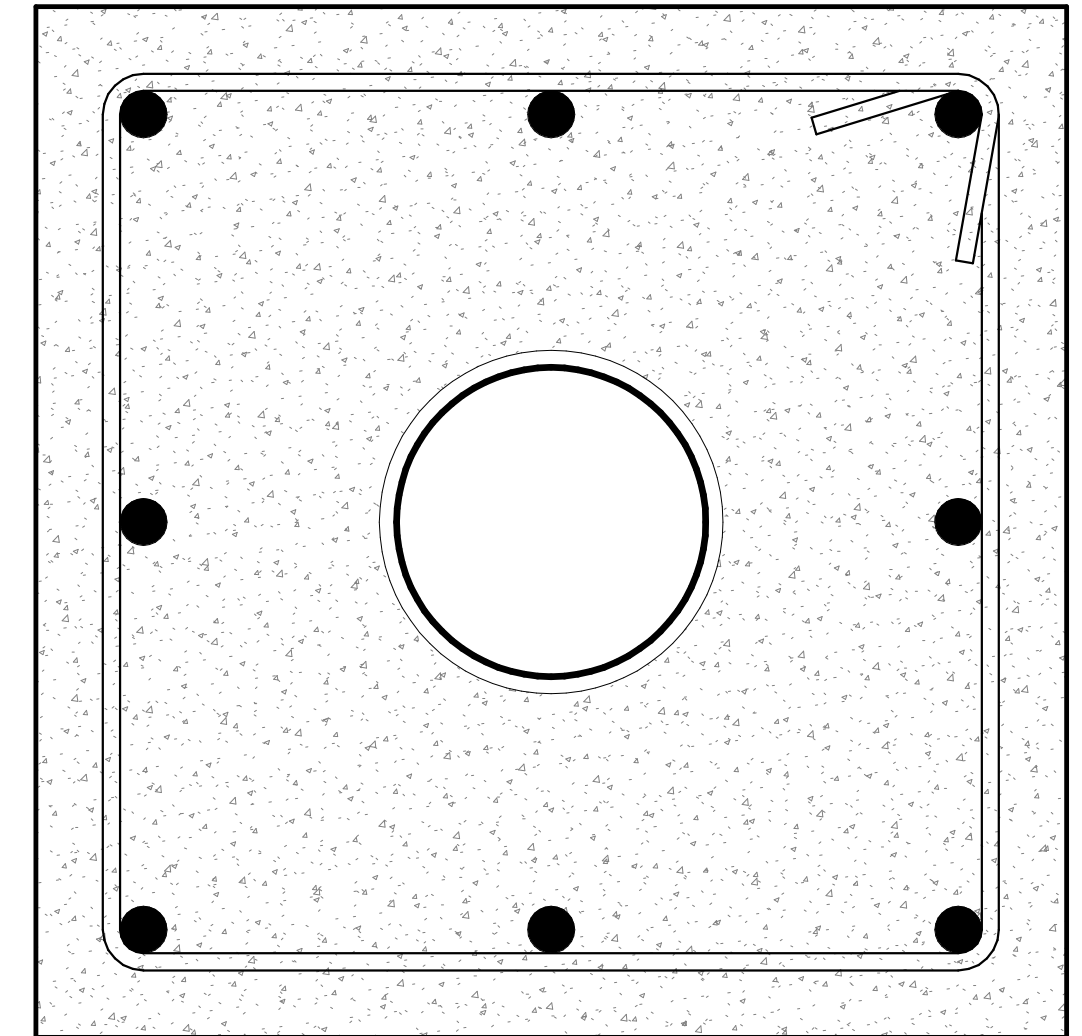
Detalle de columna de concreto reforzado con bajante pluvial. Elaboración propia.
